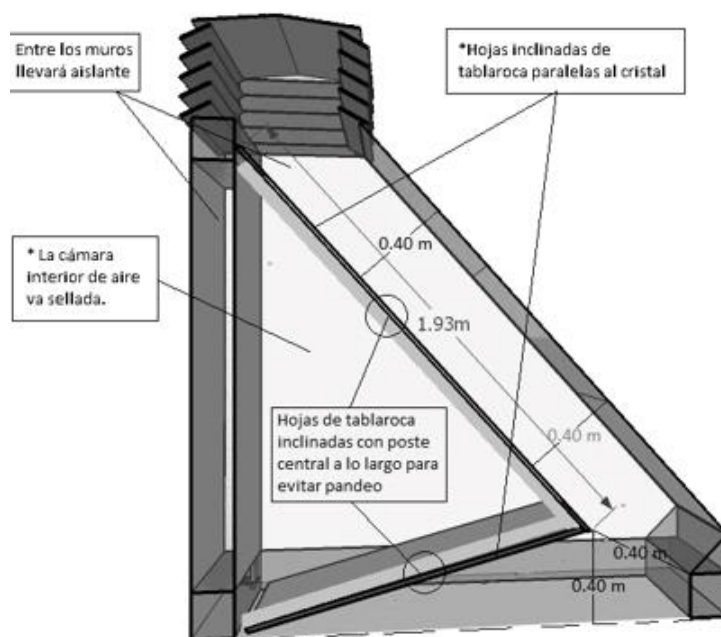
Plano de corte arquitectónico de chimenea solar. Fuente: propia
